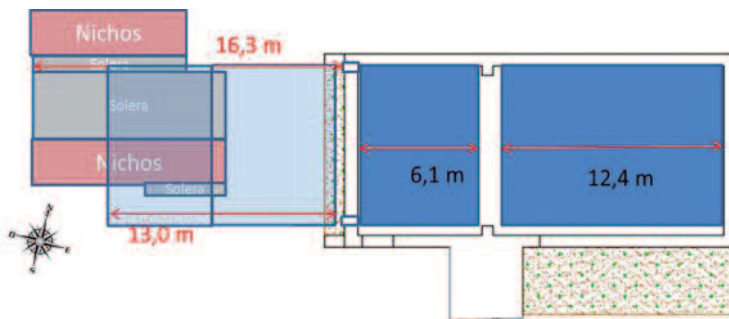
Esquema de la planta de Santa Bárbara con 3 cuerpos.
